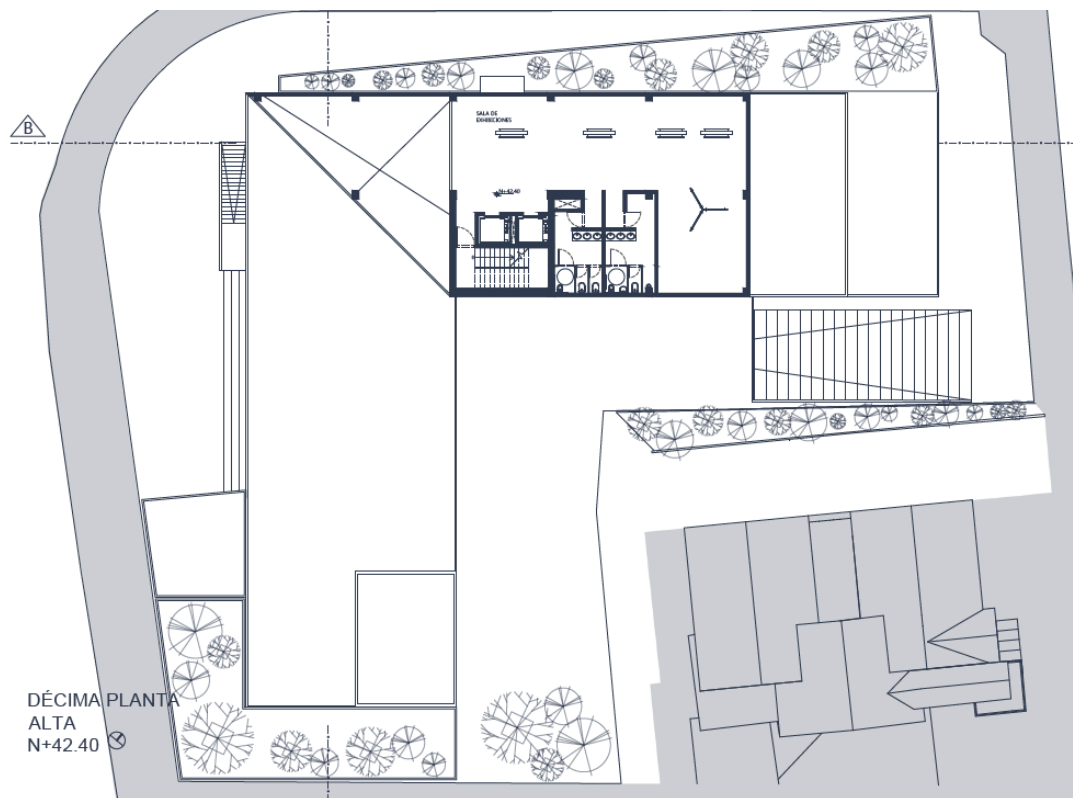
Décima Planta Alta N+42.40. Autoría propia
